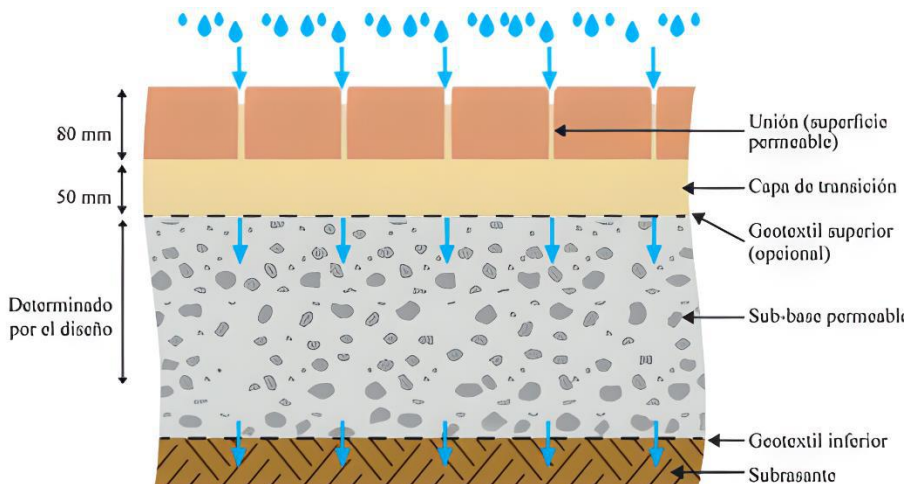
Composición de pavimento adoquinado drenante con parcial infiltración.
